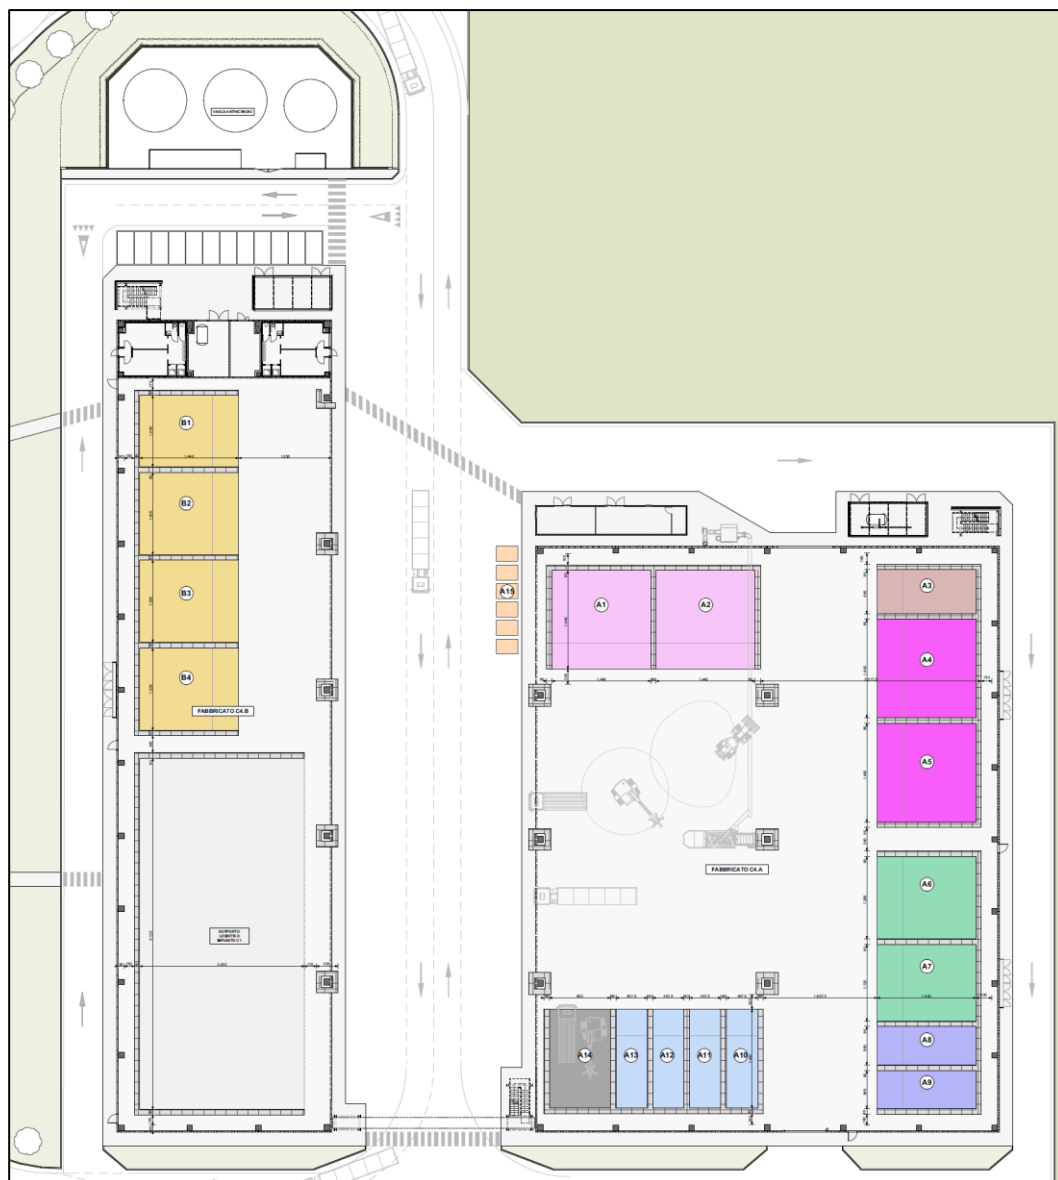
Planimetria stato di progetto con indicate le aree di stoccaggio
